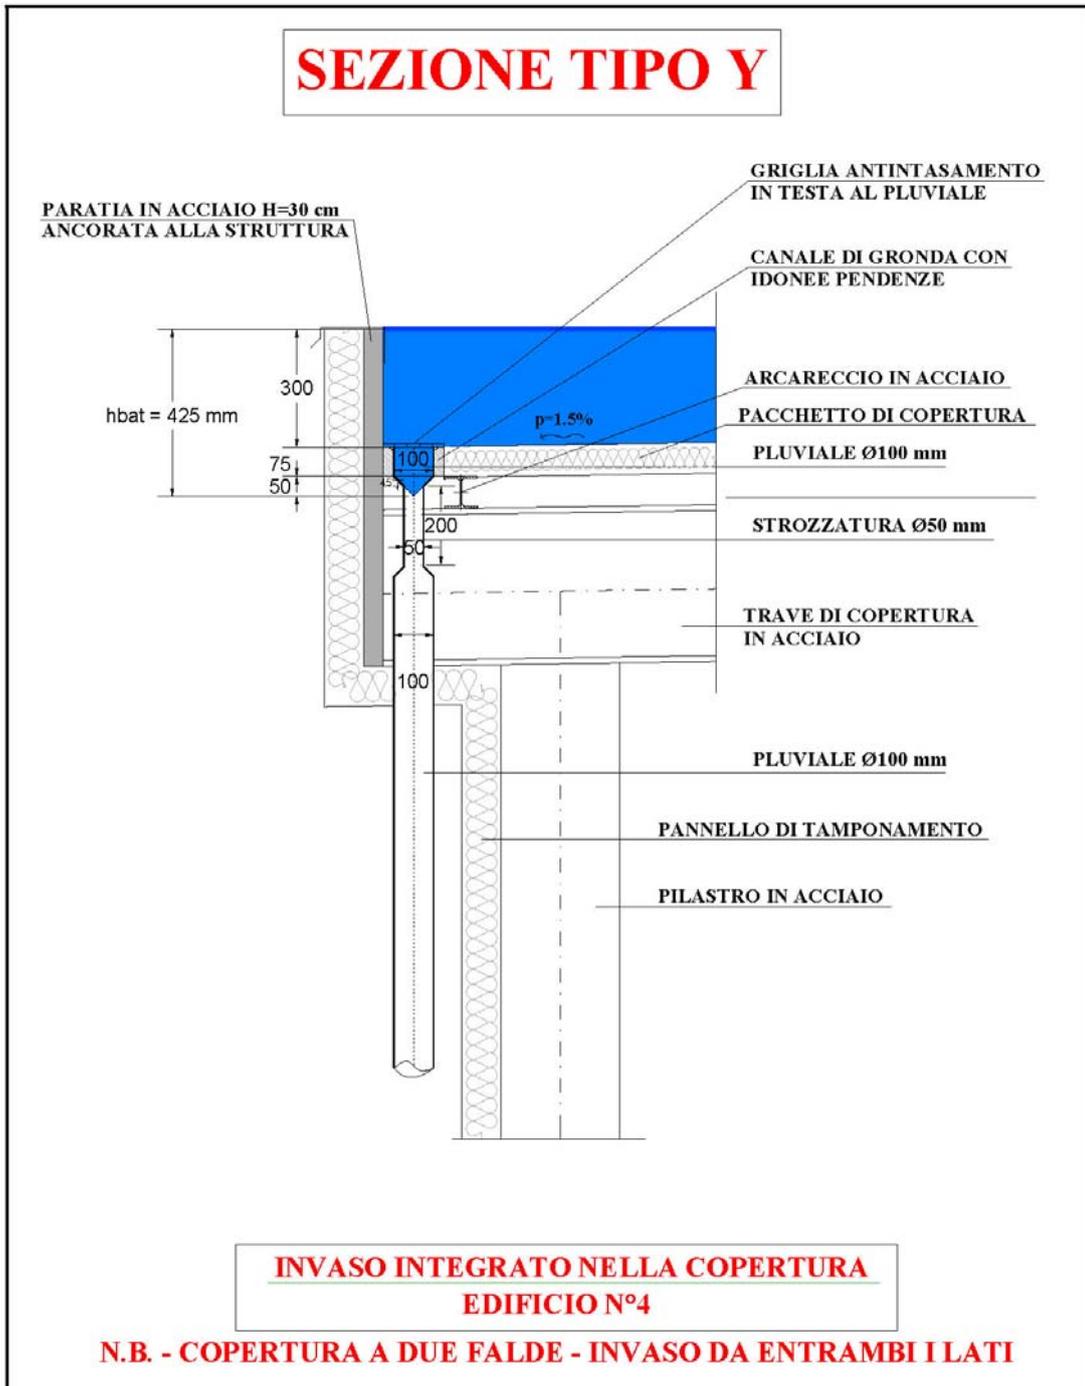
SEZIONE TIPO Y – PLUVIALI EDIFICIO N°4
